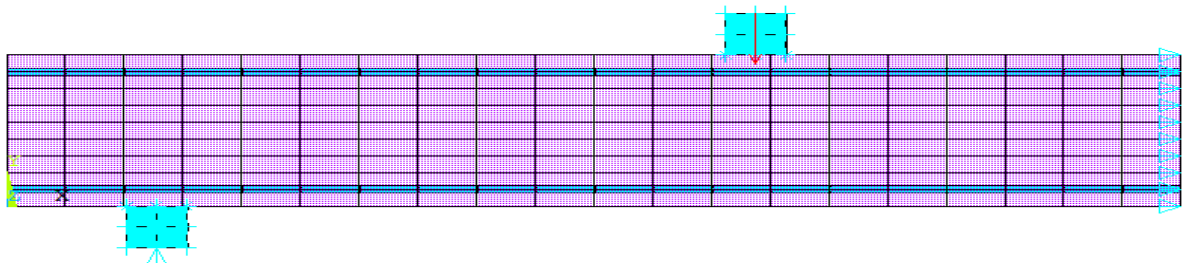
Схема навантаження SE моделі залізобетонної балки
